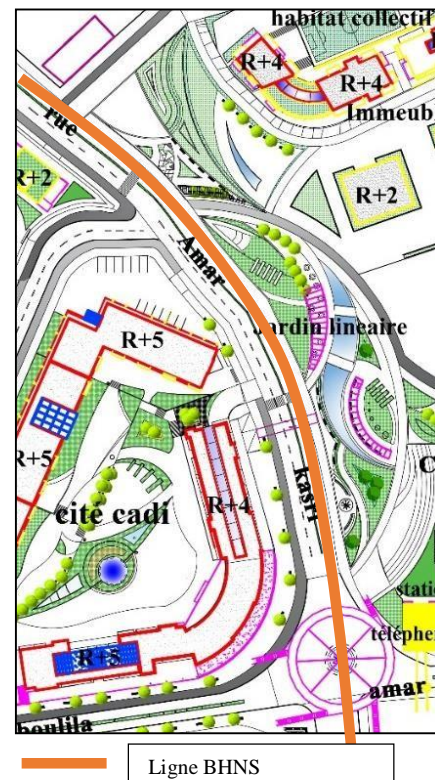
vue en plan sur la rue KESRI amar après l'intervention
